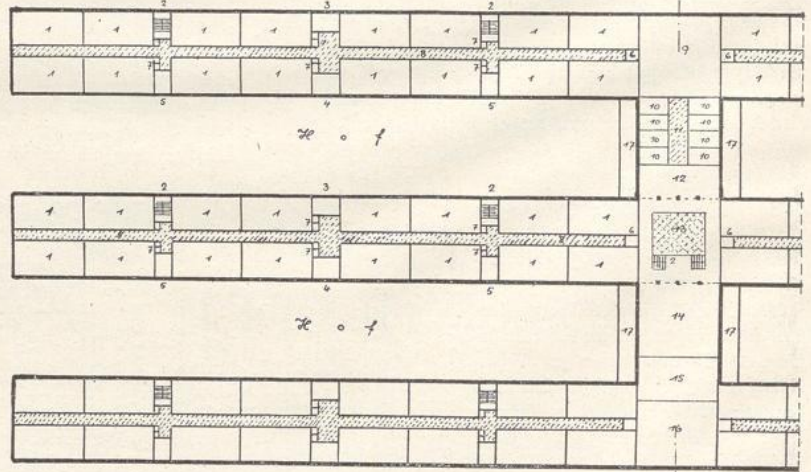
Grundrißschema für das Gemeinschaftswohnhhaus (1:1000)
